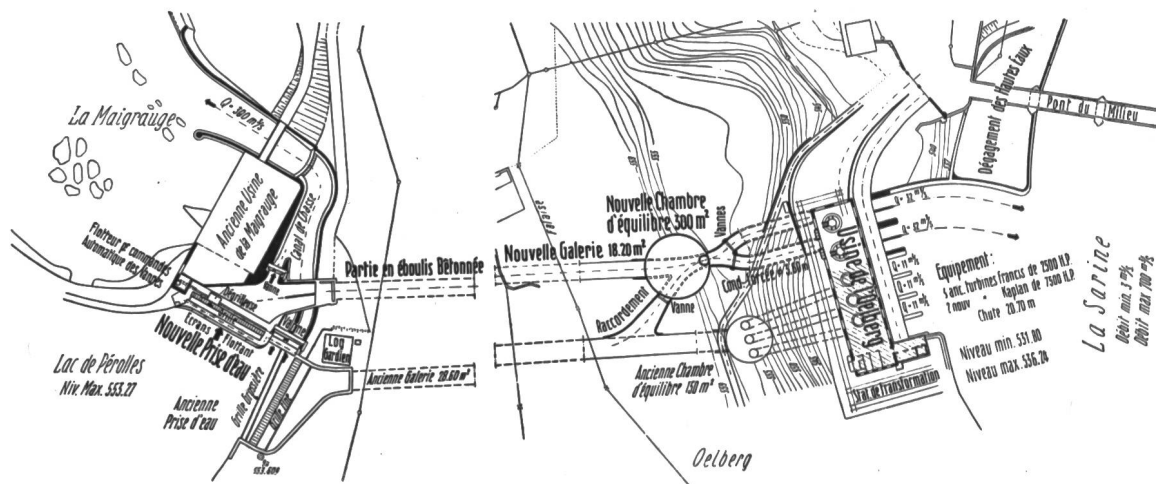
Oelberg. Plan de situation. (Nr. 6398 BRB 3. 10. 39.)
